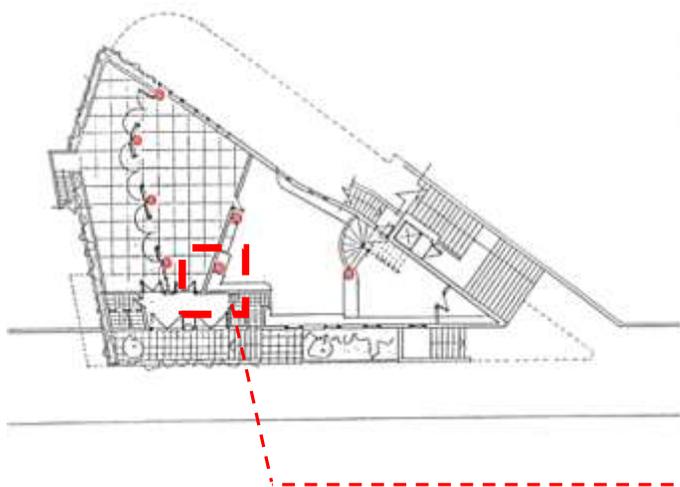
Plano indicativo del pilar. Cap Ducal, Viña del mar. (1936).
